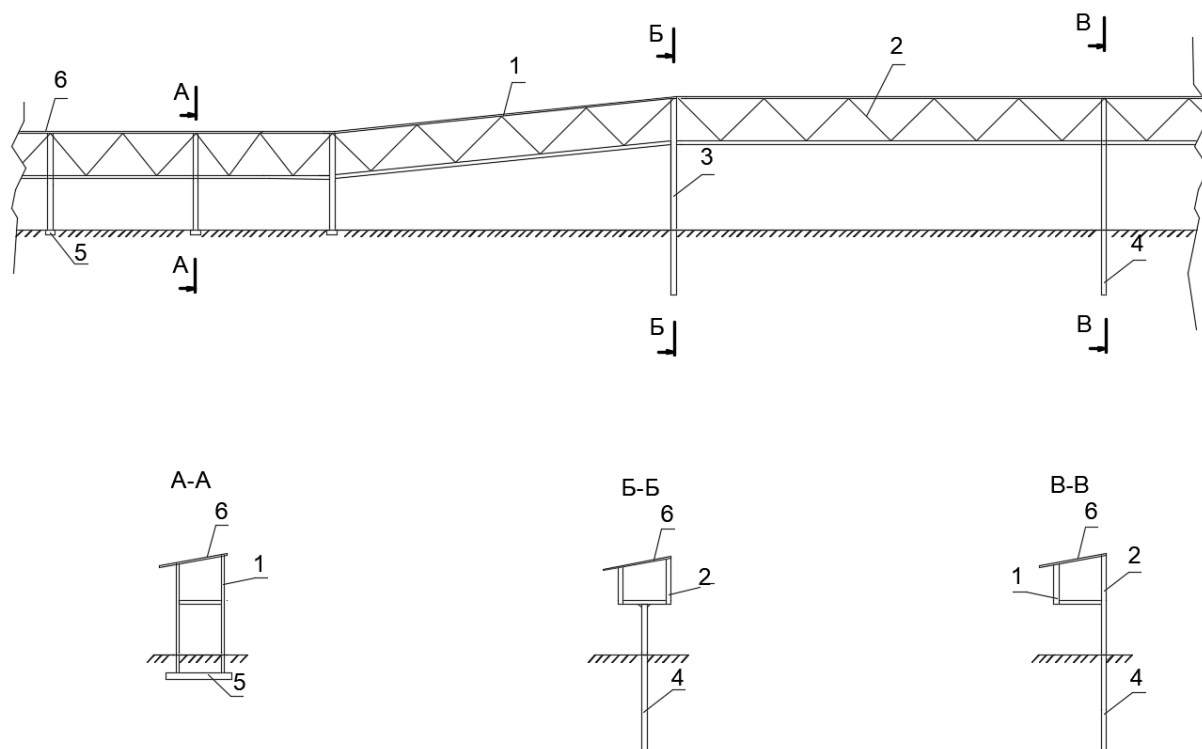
Эскиз городской велоэстакады: 1 – пролётные строения; 2 – пространственные сквозные фермы из лёгких материалов; 3 – рамные опоры из железобетона или из тех же материалов, что и пролётные строения; 4 – свайное основание фундамента; 5 – естественное основание фундамента; 6 – кровля
